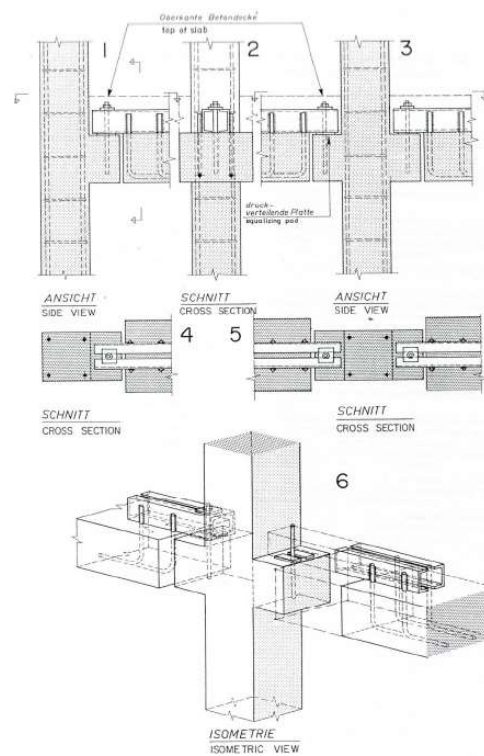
Ligação por consolo de betão (Stupré, 1981)
